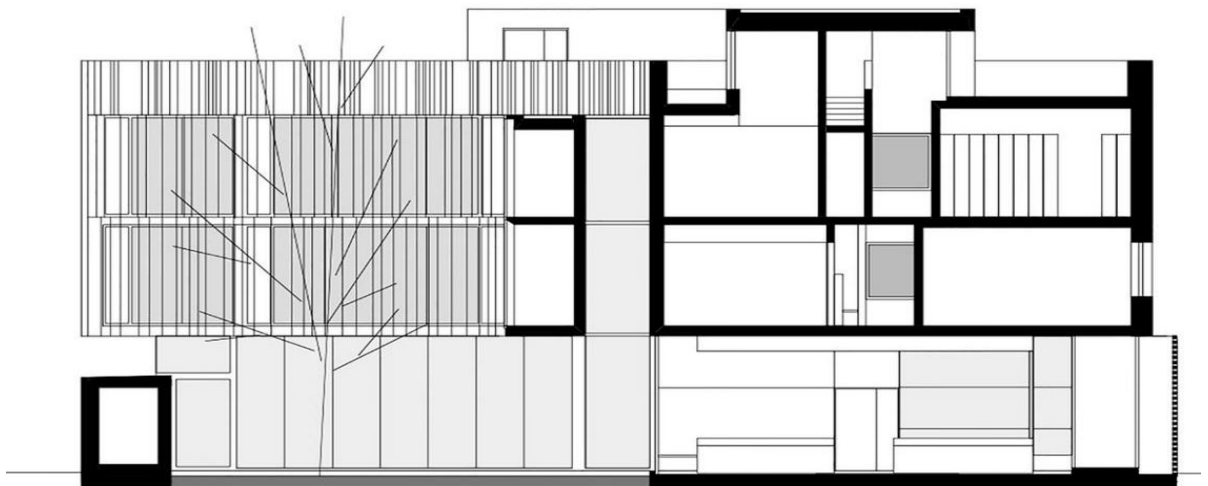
Sección vista posterior. Fuente archdaily.mx. Sin escala.
